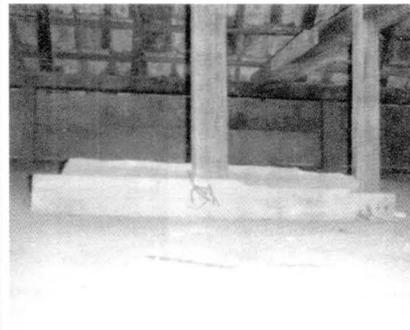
Ruang *durung* di Bawean alas ruang di loteng dari papan ditata rapat
